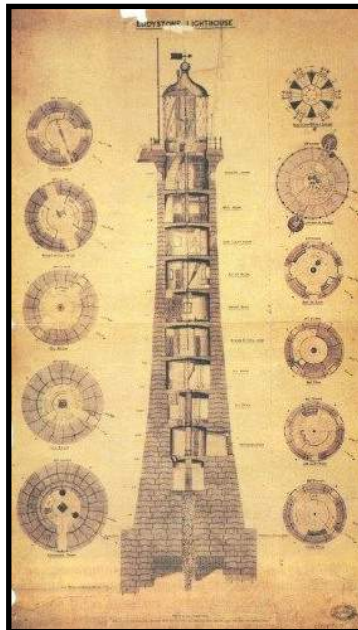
Plano de faro de Edystone (John Smeaton – 1759)
